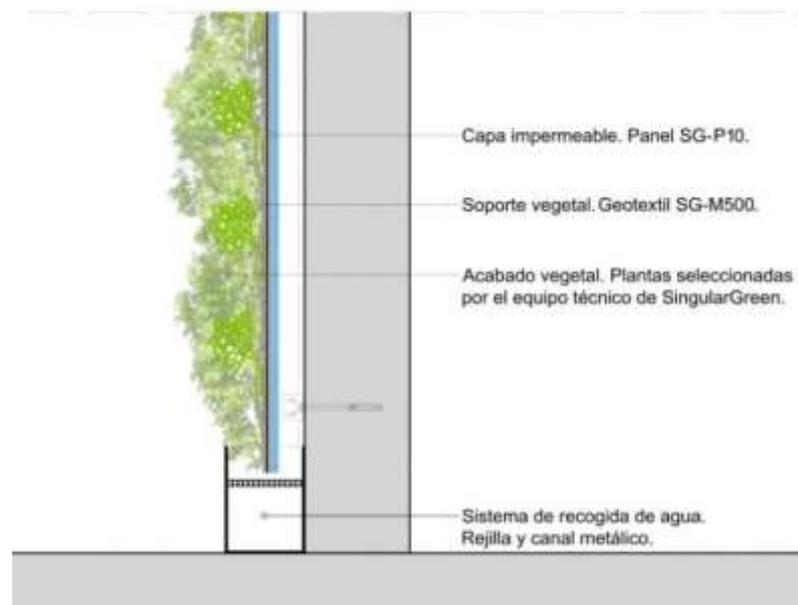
Detalle constructivo de sistema por medio de fieltros geotextiles
